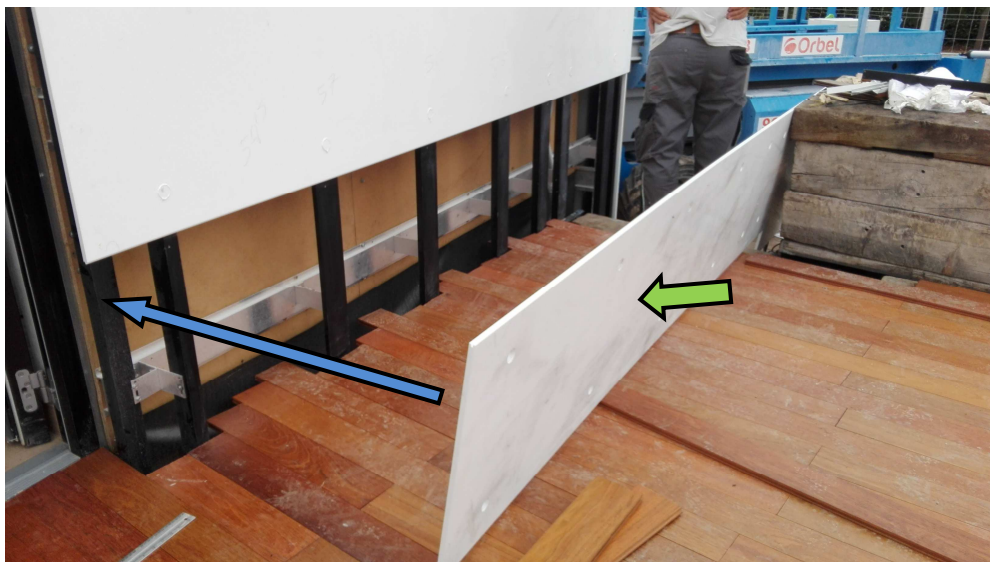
Colocación de la placa inferior del Krypton / [EP]
